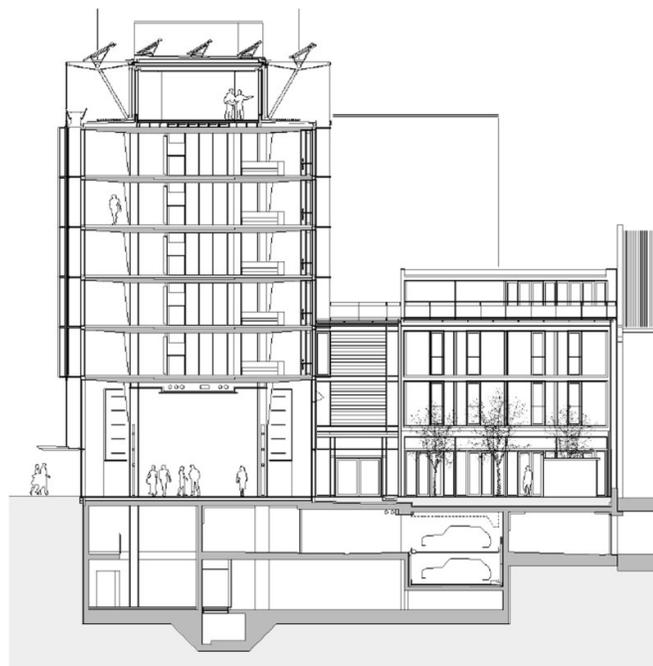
Corte transversal. (Nachhaltiges bauen, 2011)
